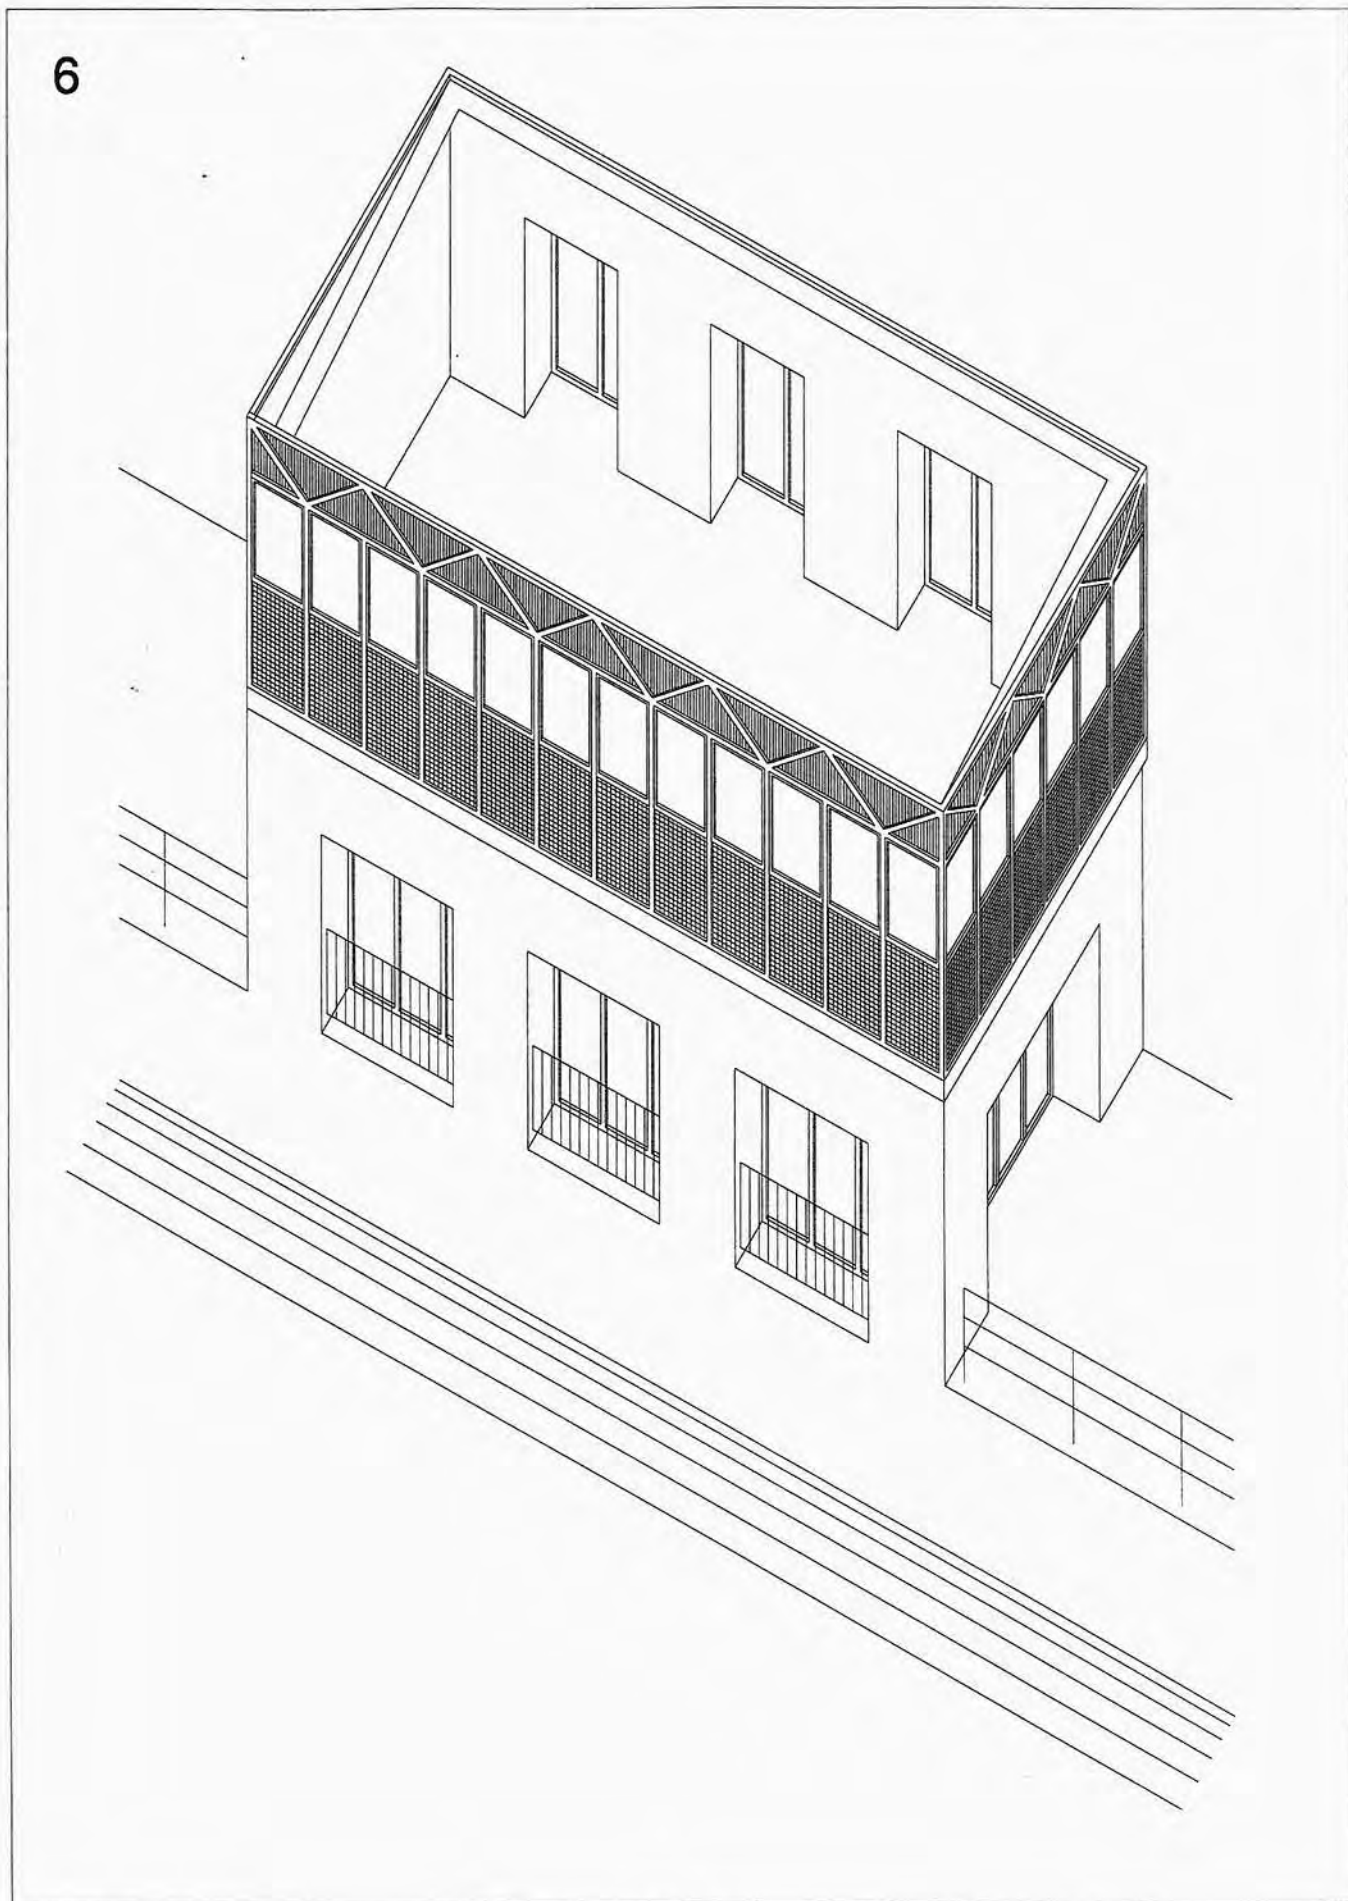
ESEMPIO DI PARAPETTO DELLE TERRAZZE
